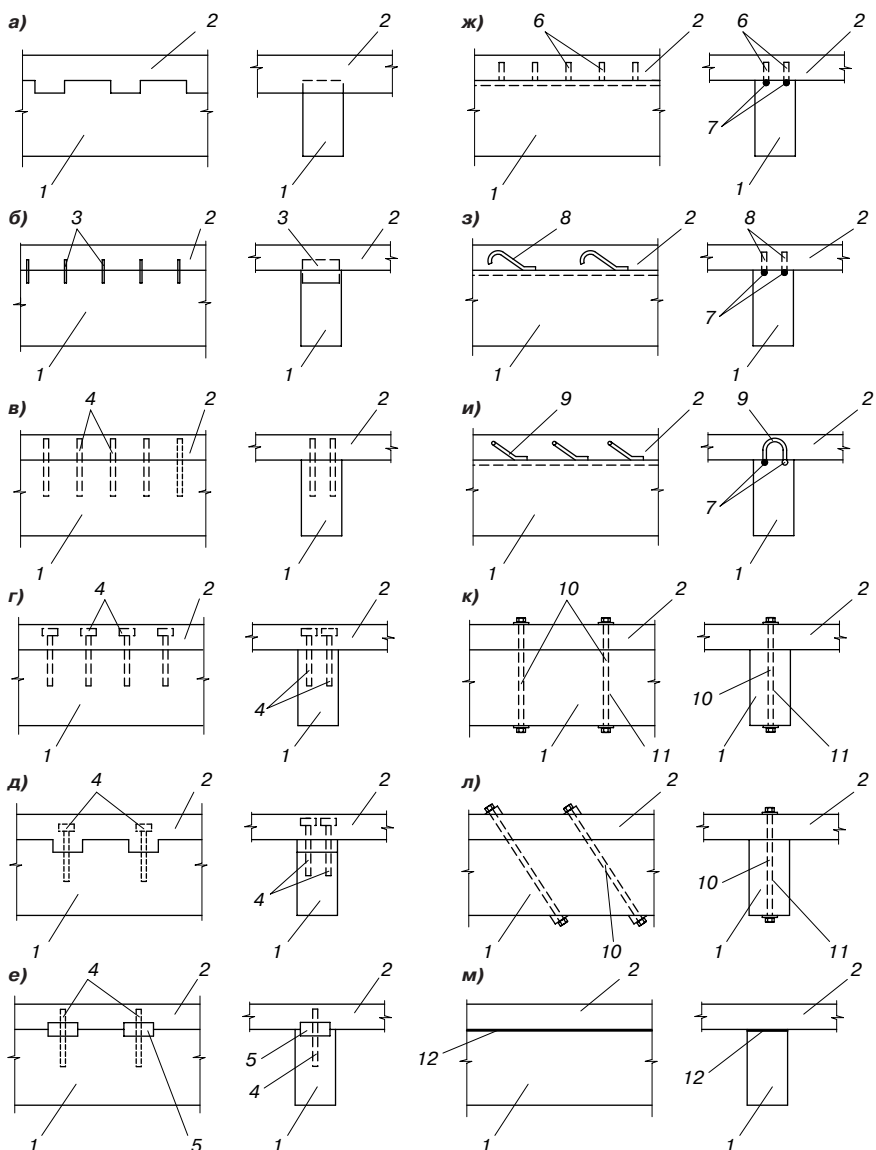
Типы соединений железобетонной плиты с деревянной балкой: 1 – деревоклееная балка; 2 – железобетонная плита; 3 – стальная пластинка; 4 – стальной нагель; 5 – стальная цилиндрическая шпонка; 6 – стальной стержневой упор; 7 – связывающая основа; 8 – одиночный стальной анкер; 9 – петлевой стальной анкер; 10 – напряженные болты или пряди; 11 – отверстия; 12 – клеевое соединение
